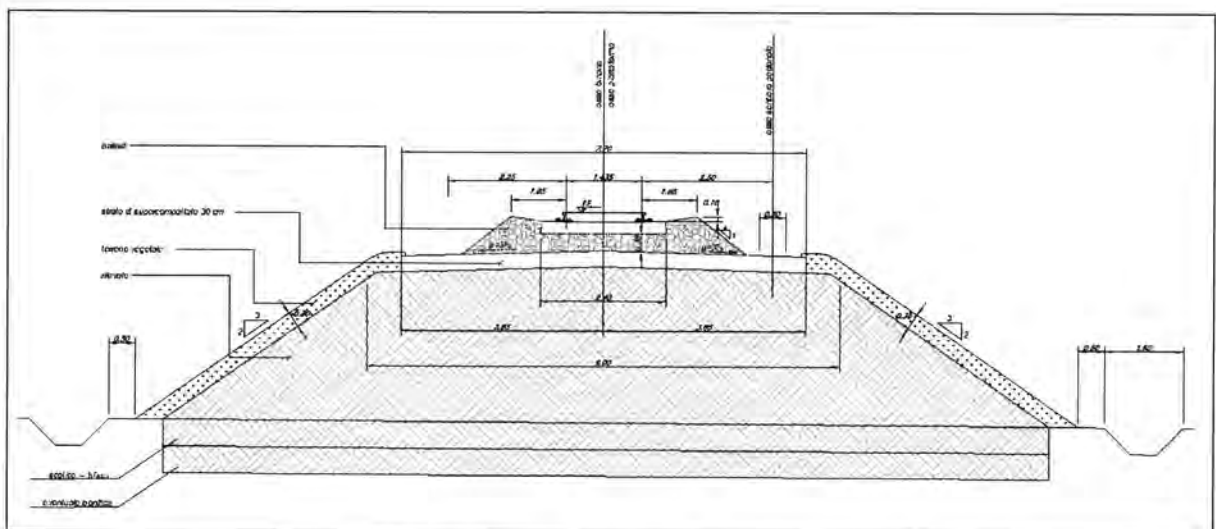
Sezione tipo rilevato deviata provvisoria
